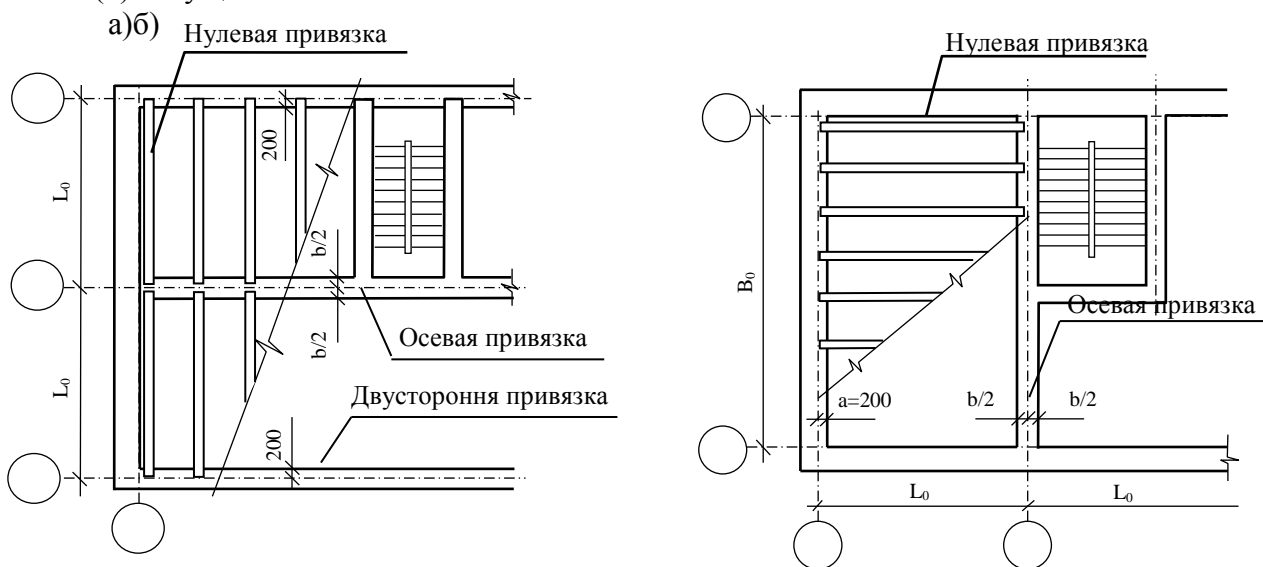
Конструктивная схема с продольными (а) и поперечными (б) несущими стенами.
